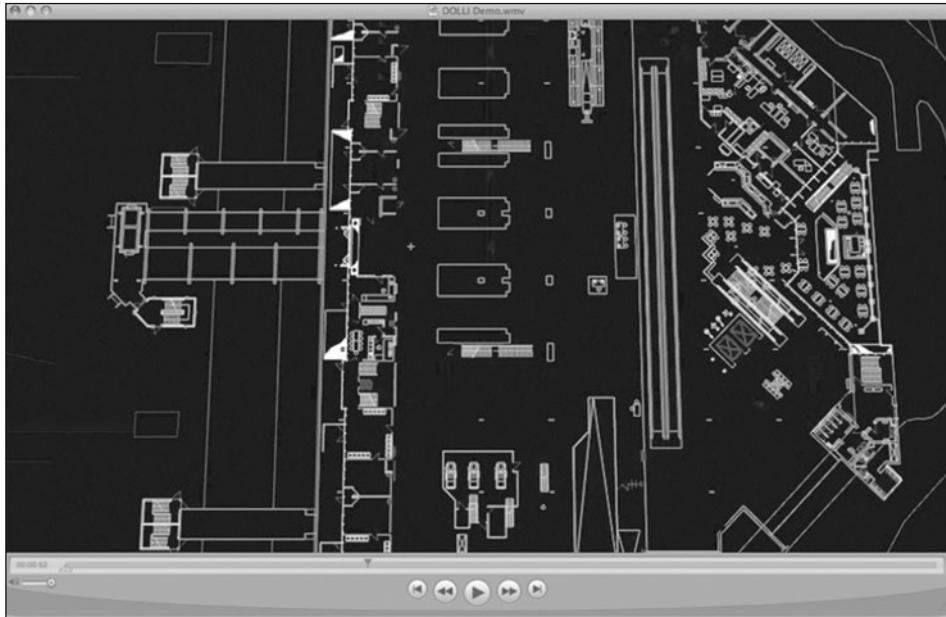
LaVIS Gebäudeansicht (Grundriss) mit Halle, Rolltreppen und Büros
